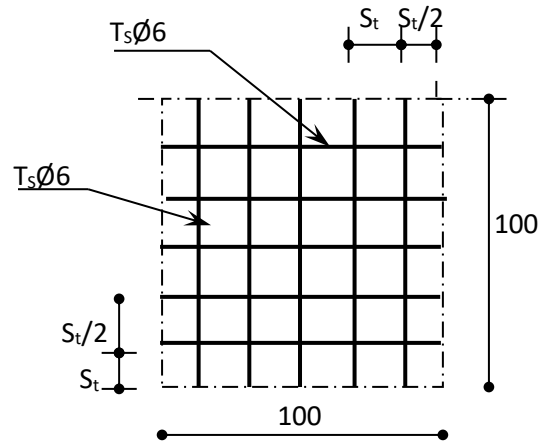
Disposition constructive des armatures de la dalle de compression.
